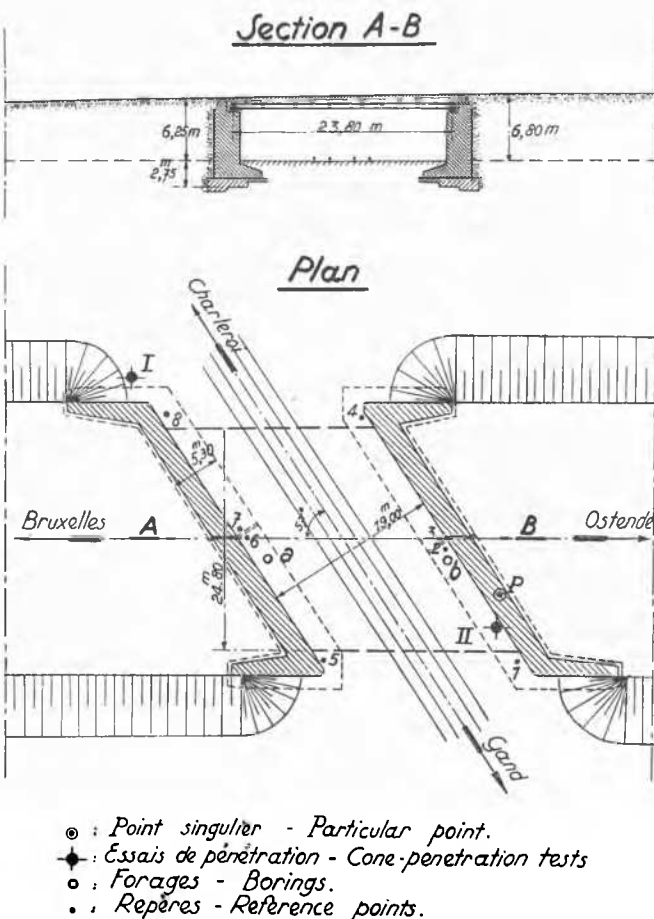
Pont No 22 à Gontrode: vue en plan et coupe
